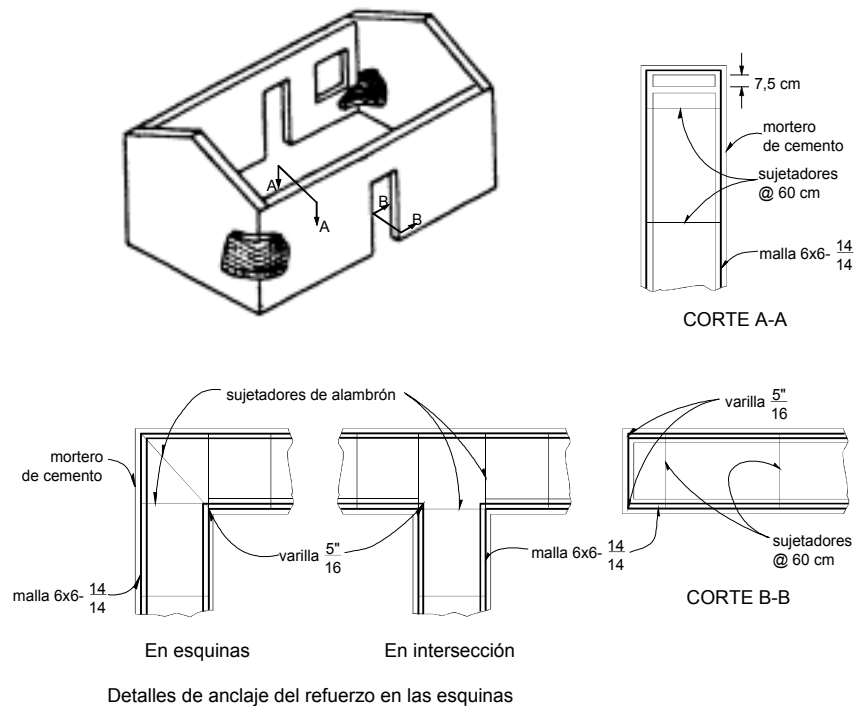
Encamisado de muros de adobe con mallas metálicas recubiertas con mortero
